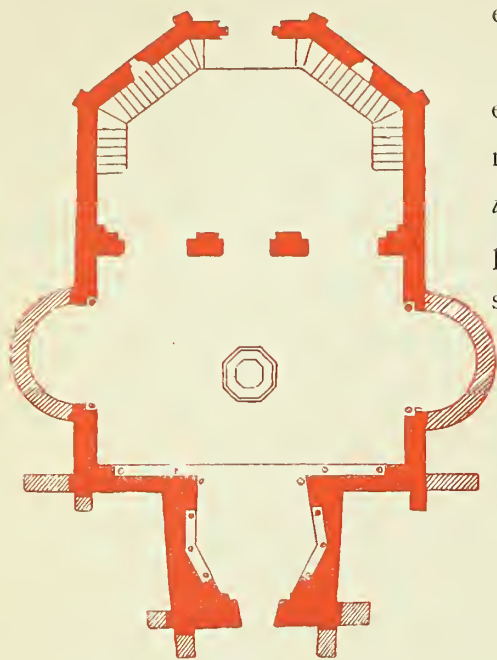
PLANTA DEL BAPTISTERIO DE SAN JUAN EN POITIERS
